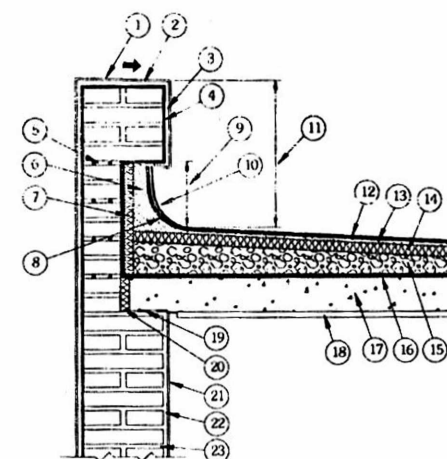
Encuentro de cubierta con parapeto, techo del tipo "semi-frío" (sin protección mecánica).
